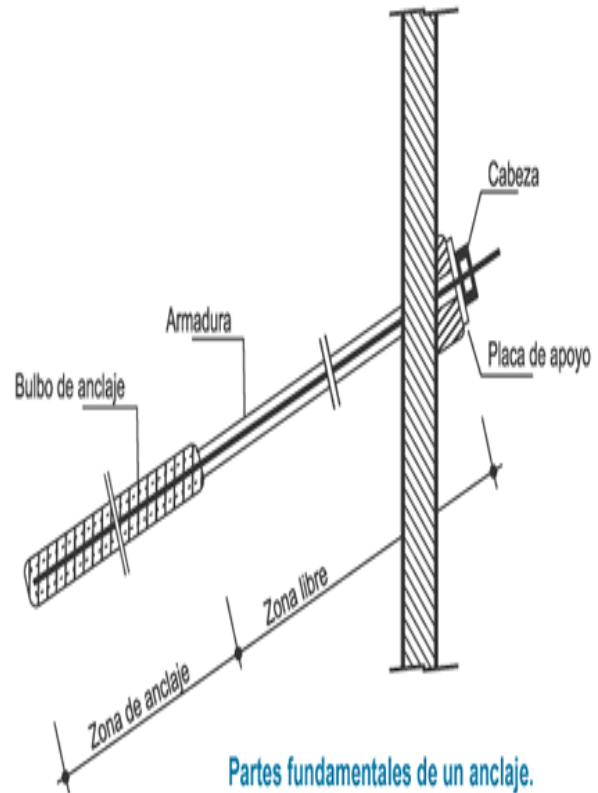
Partes de un anclaje. (Ref. Internet 4)
